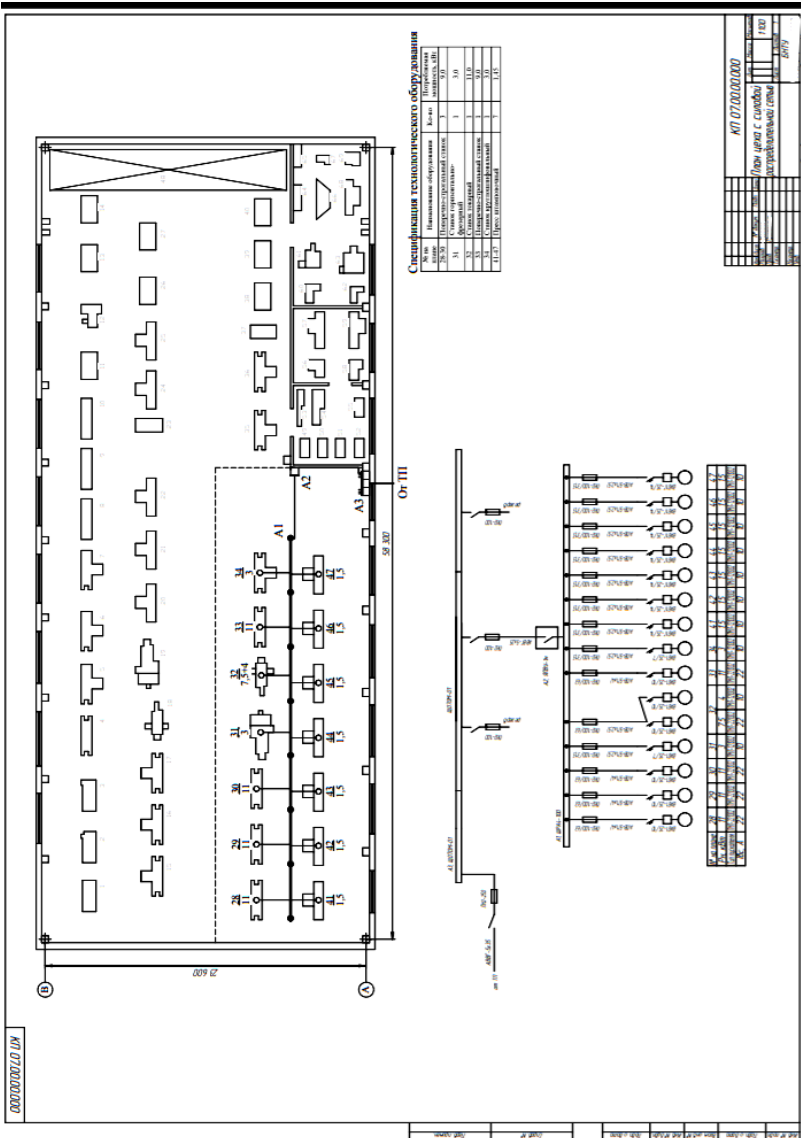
План цеха со схемой распределительной сети и расчетная схема для группы станков цеха № 3
